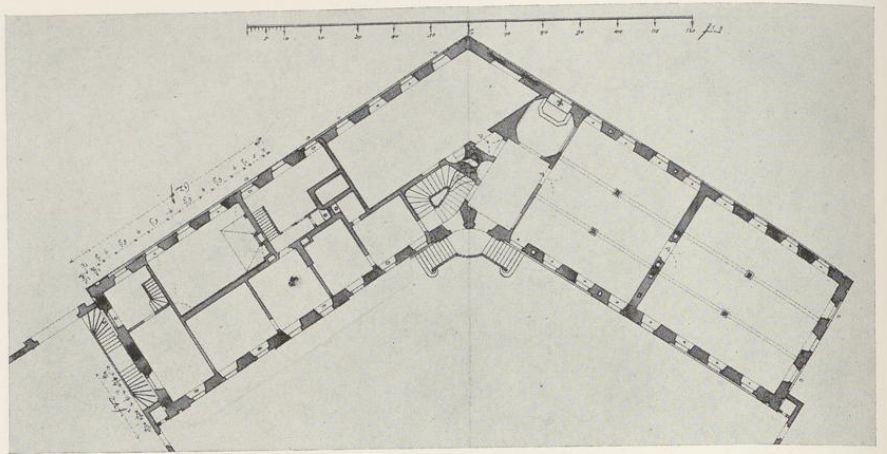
Grundriß des ersten Geschosses des Zuchthauses (zweiter Entwurf). Norden oben
